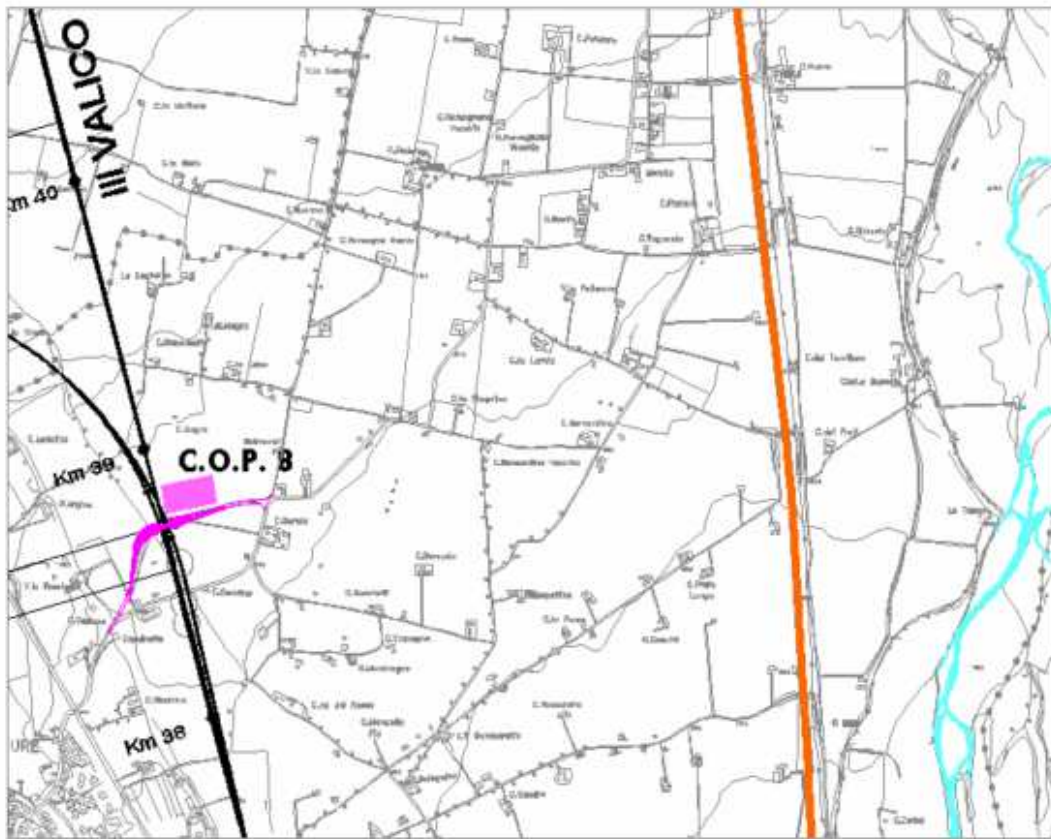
Stralcio planimetrico con indicazione dell'ubicazione del cantiere Operativo C.O.P.8 per la soluzione di Progetto Definitivo
